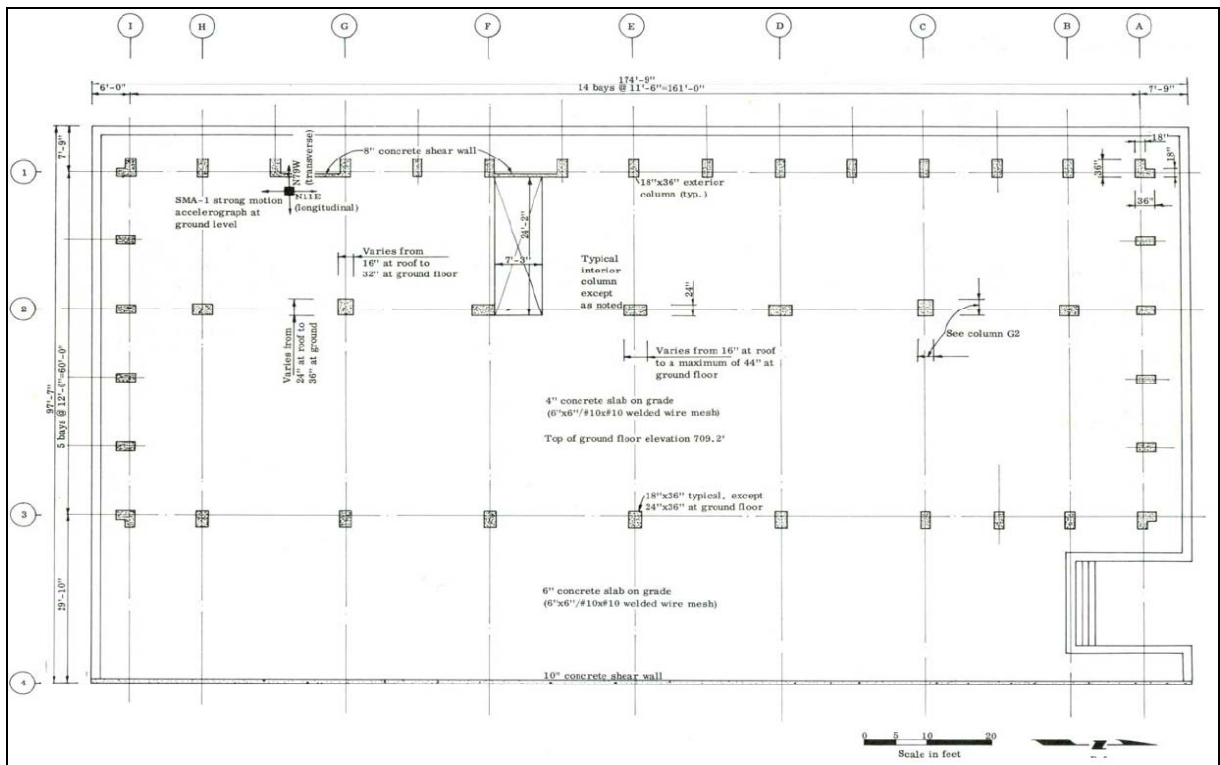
Planta de estructura 1º piso edificio Bank of California. (NOAA, 1973)
